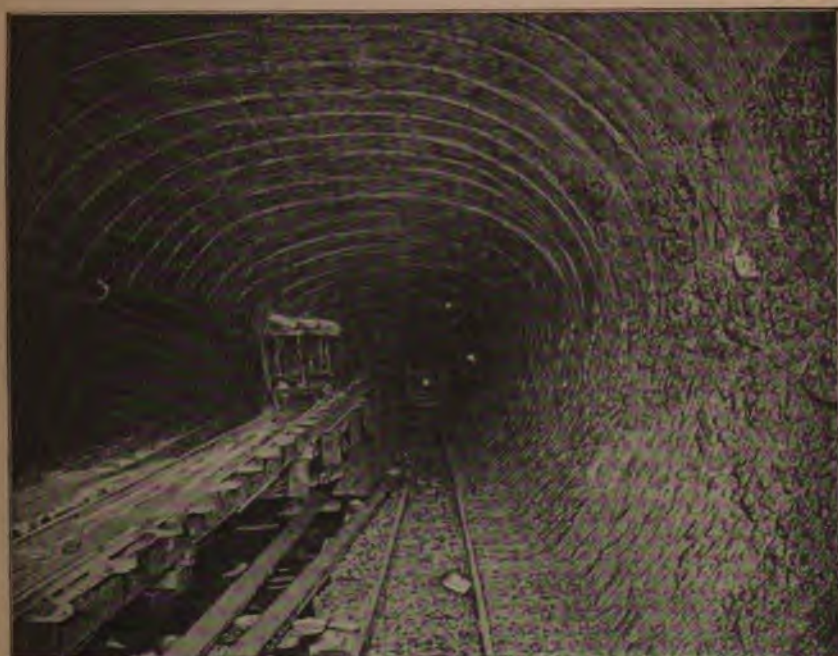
Voie de service des déblais et rampe d'accès au plancher des maçons.
